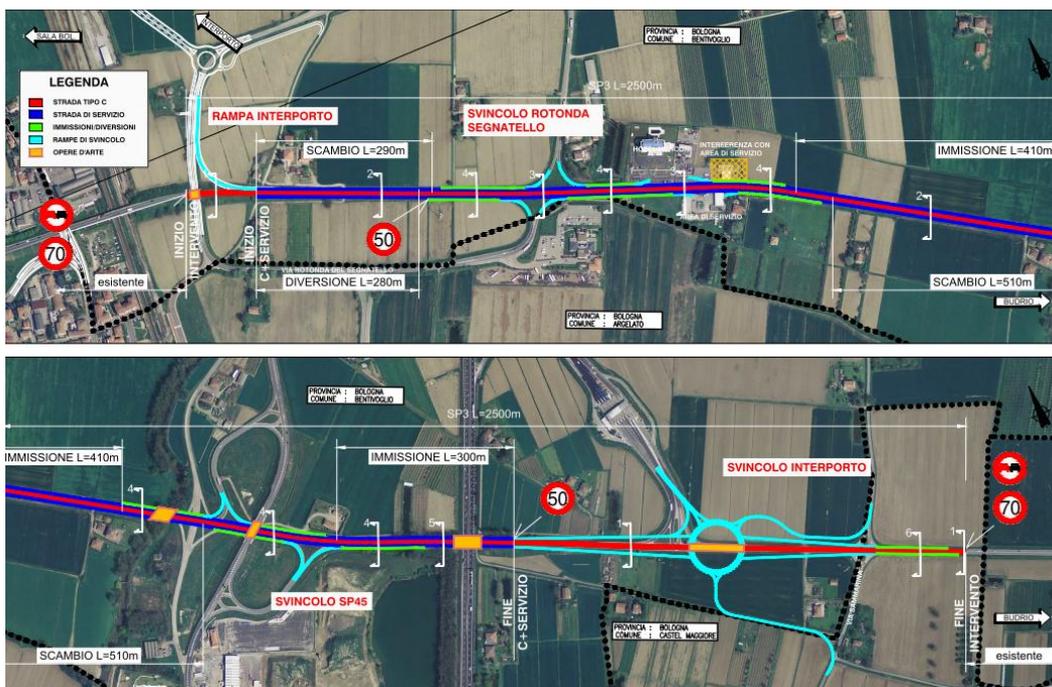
Stralcio su ortofoto dell'intervento in progetto
